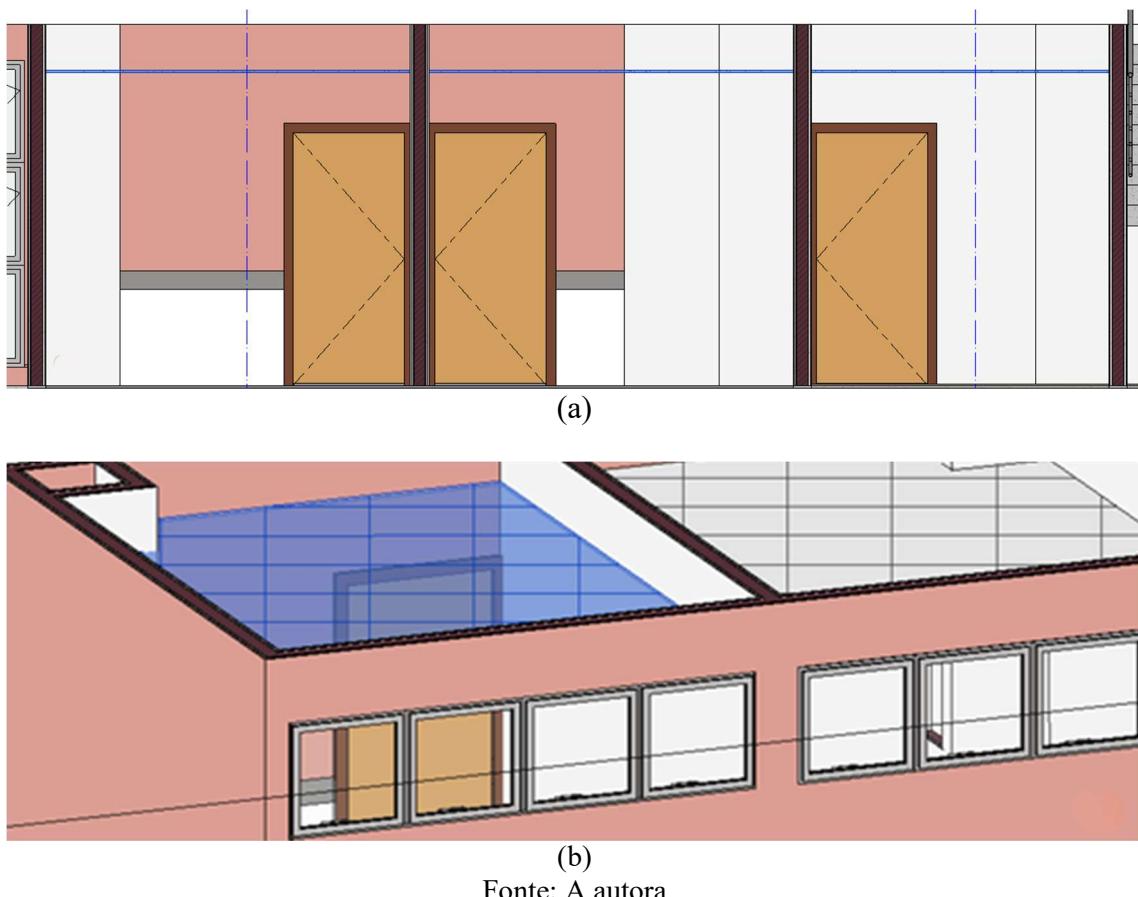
Pisos modelados no pavimento térreo da edificação - Revit
